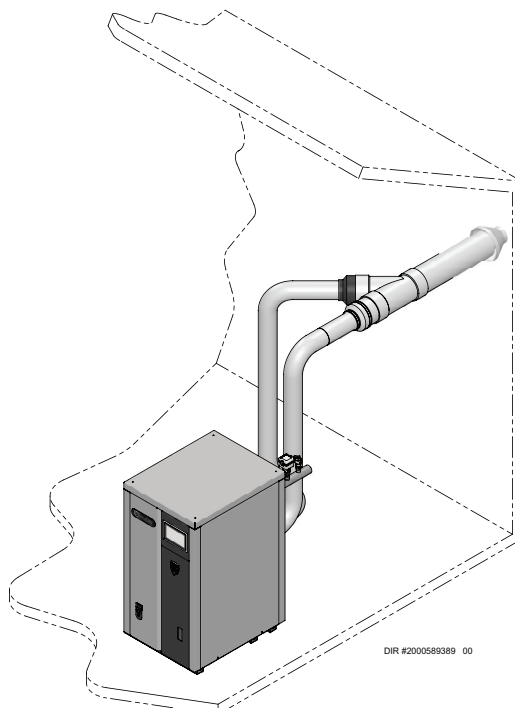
Terminaison concentrique murale en PVC/CPVC
